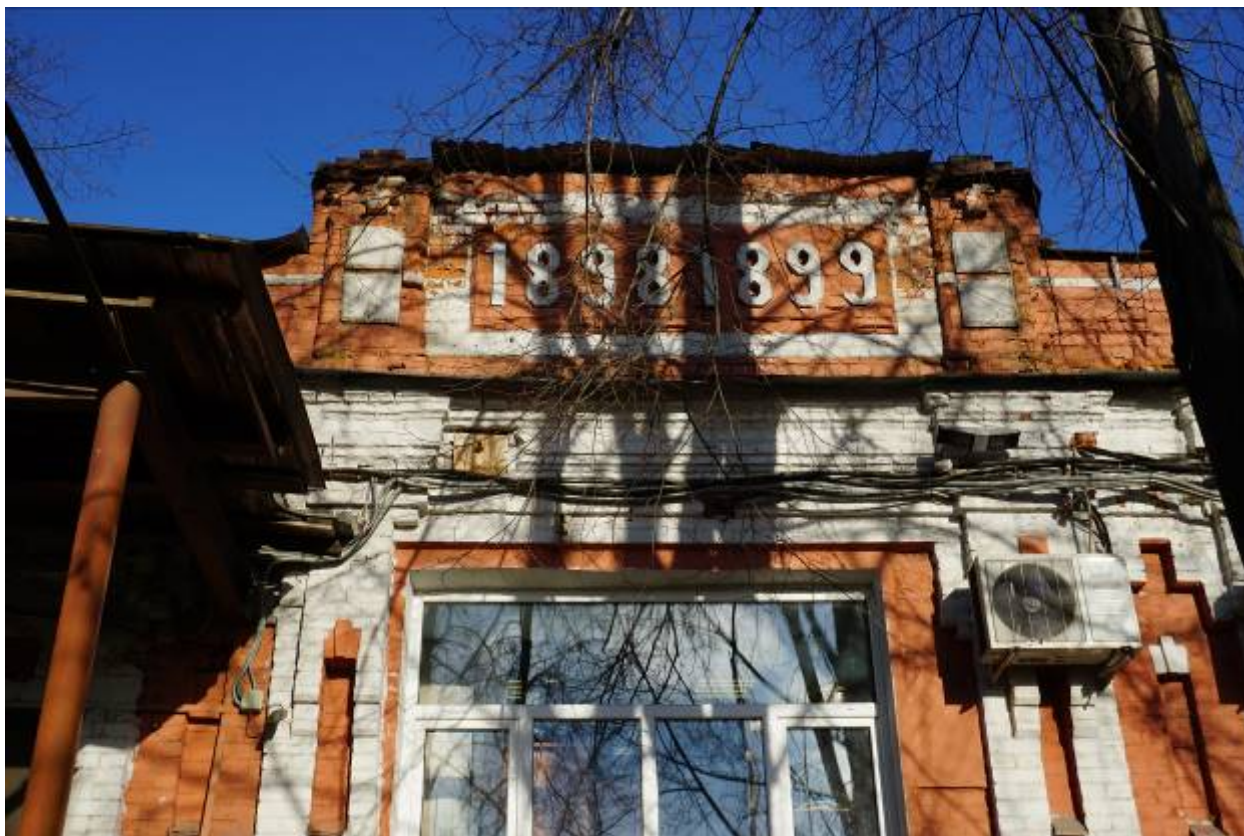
Фрагмент южного фасада здания. Вид на прямоугольный аттик.
